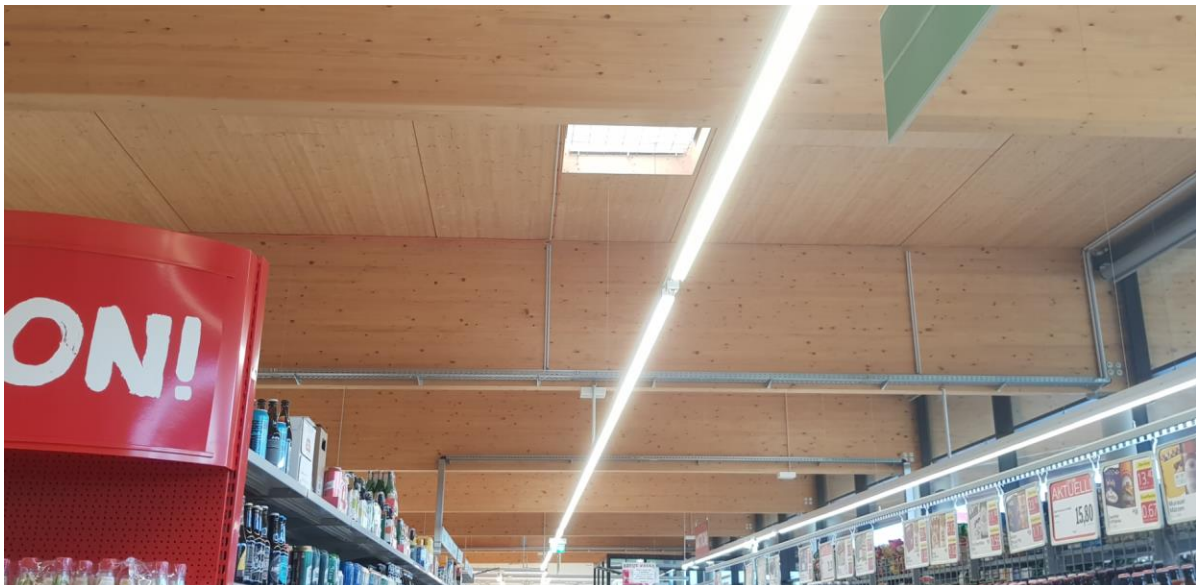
Leimbänder in der Hauptspannrichtung und darüber liegende Dachkonstruktion, Vogau
